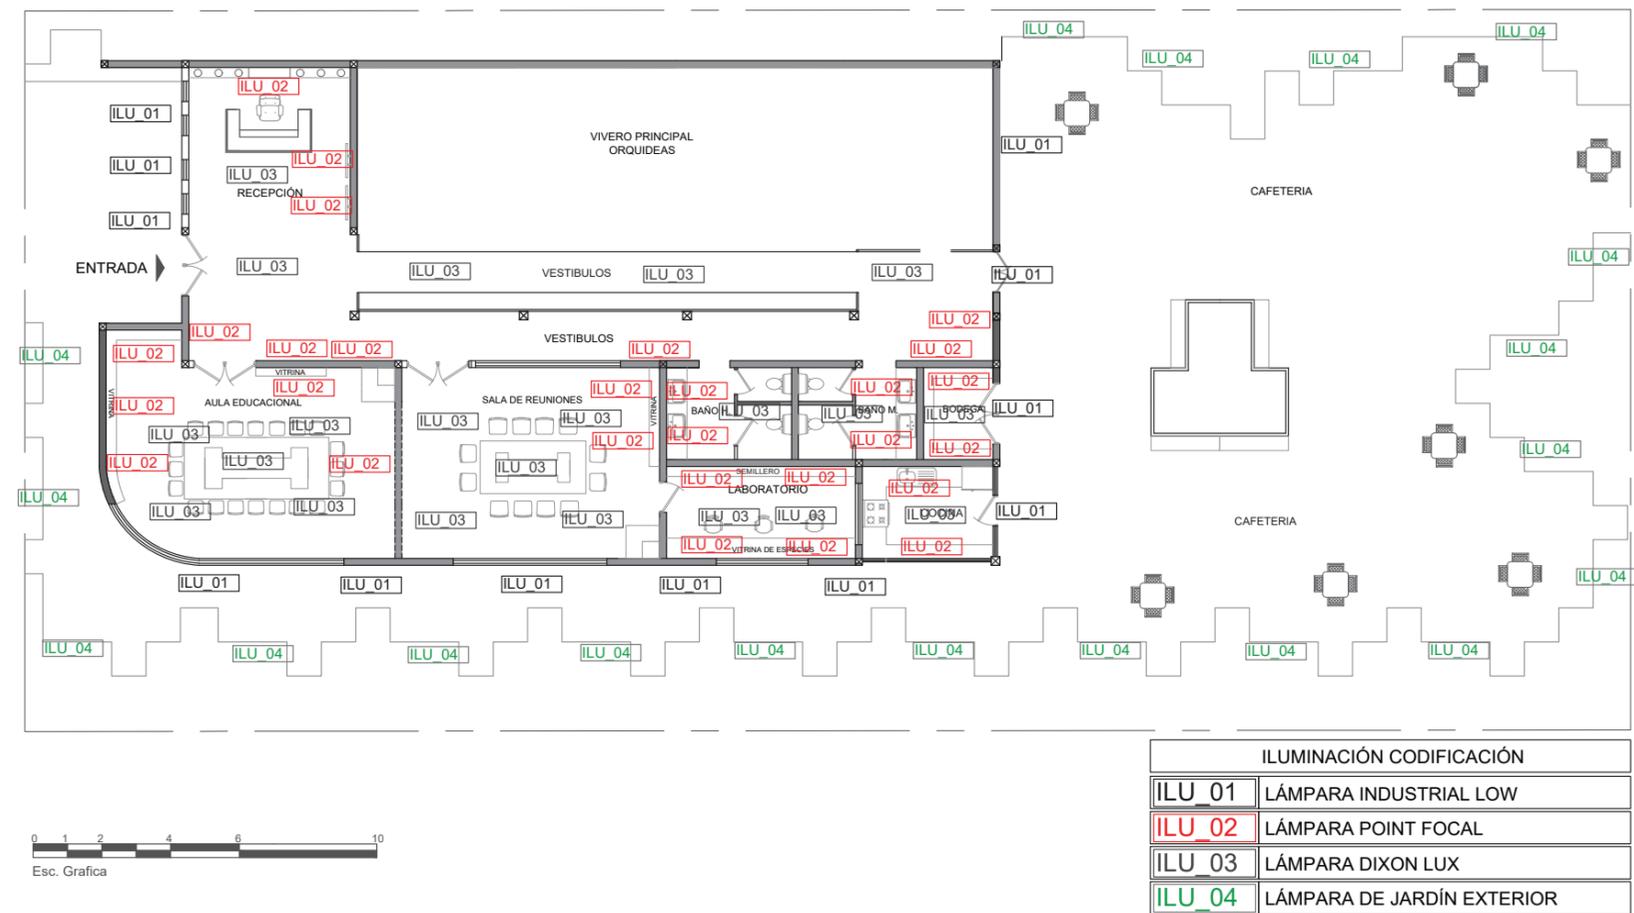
PLANTA PROPUESTA DE CODIFICACIÓN ILUMINACIÓN
